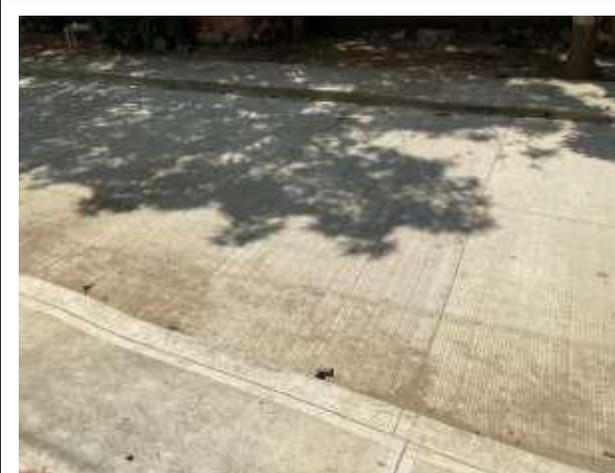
Losas con corte superficial longitudinal y transversal desde K0+000 hasta K0+131.
